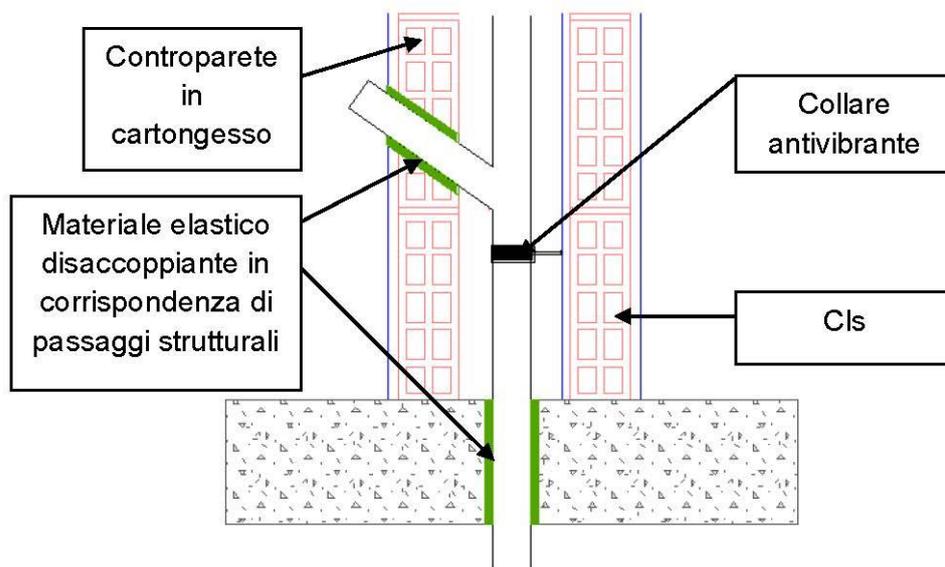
particolare indicazione per isolamento fori nel muro e nella soletta
